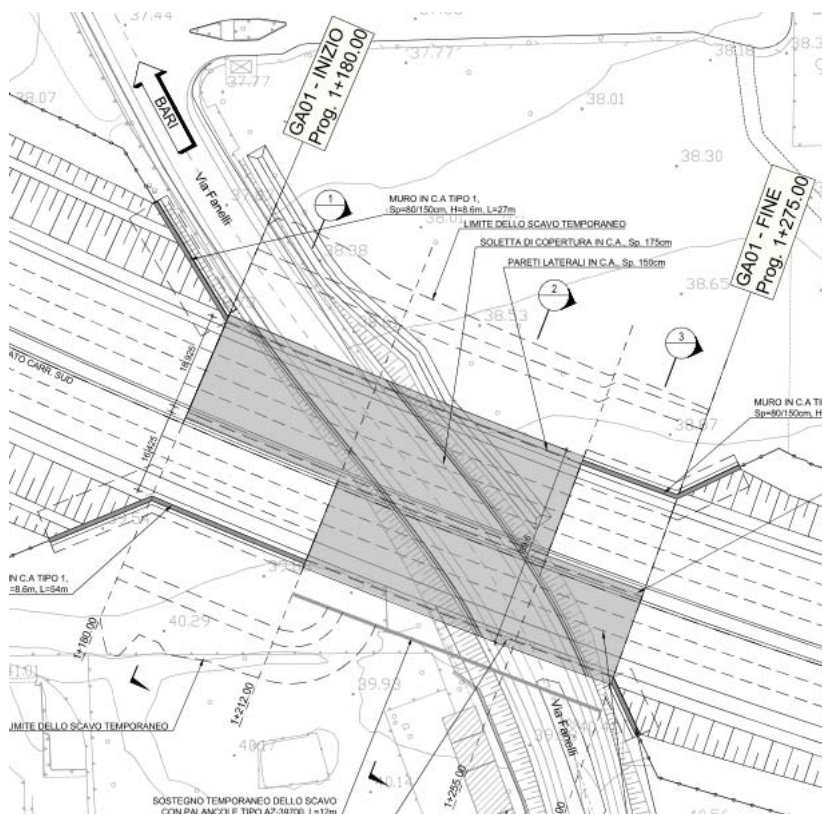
Esempio Galleria artificiale GA-01: Planimetria
